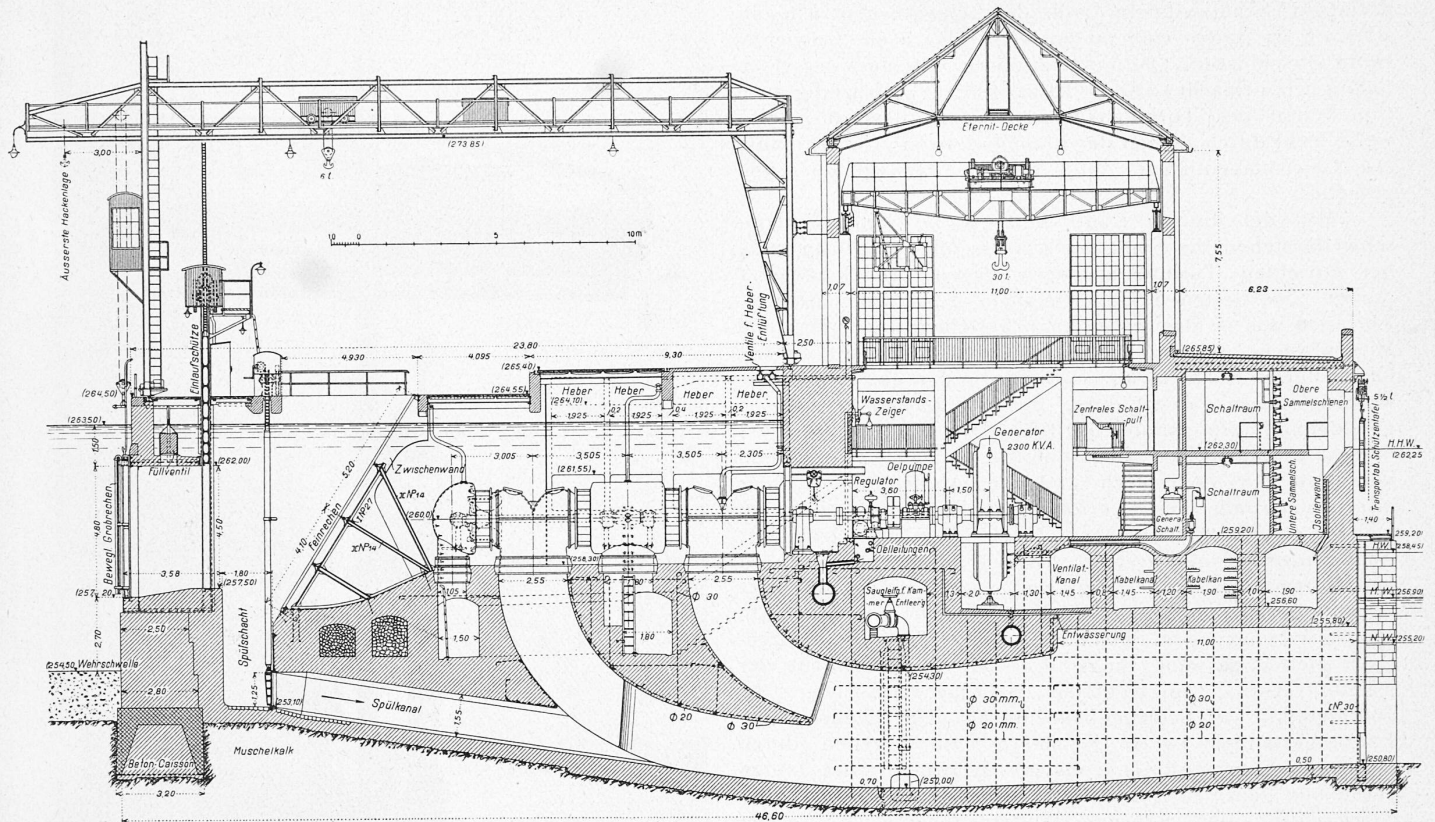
Querschnitt durch Einlauf, Turbinenkammer und Maschinenhaus. — Masstab 1 : 250.
